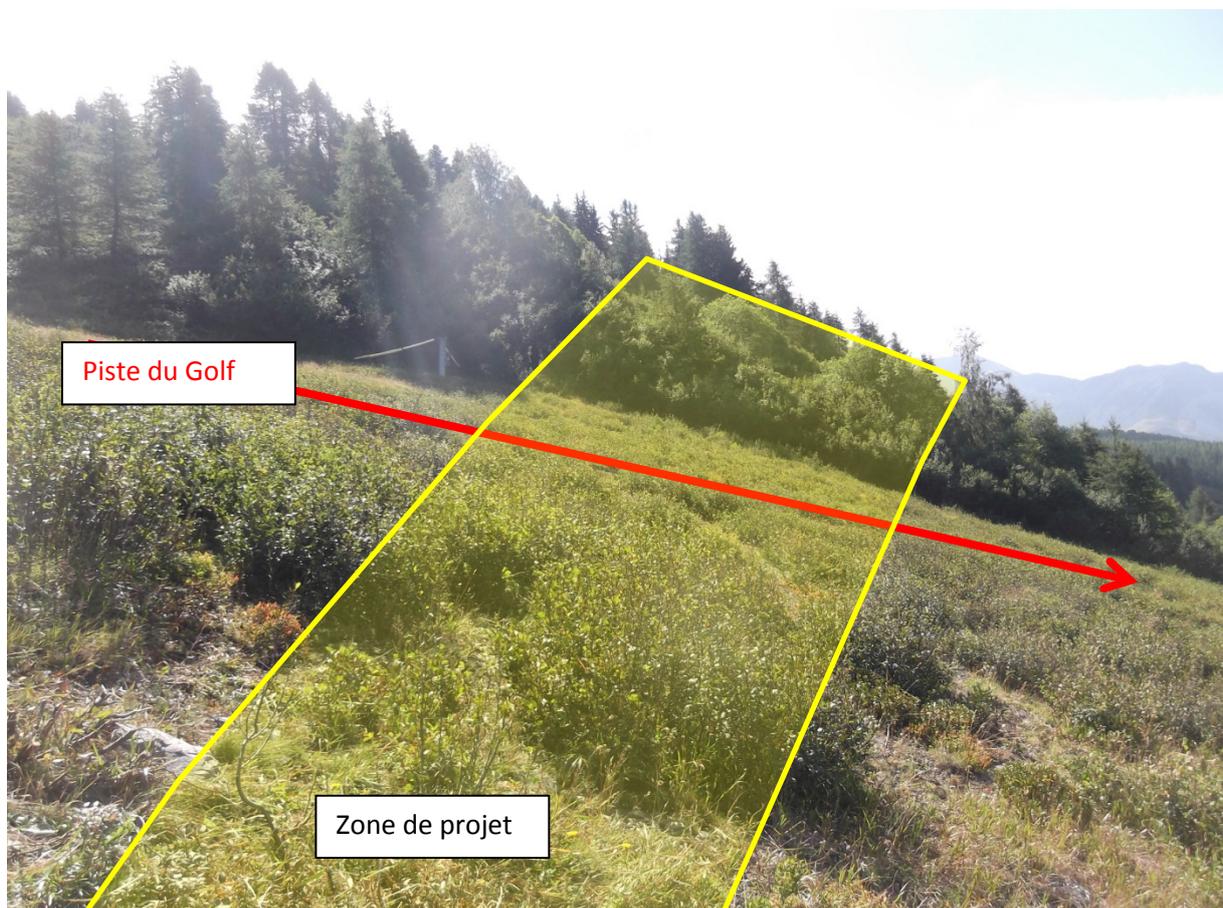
zone d'arrivée de la piste après avoir traversé la piste du Golf
